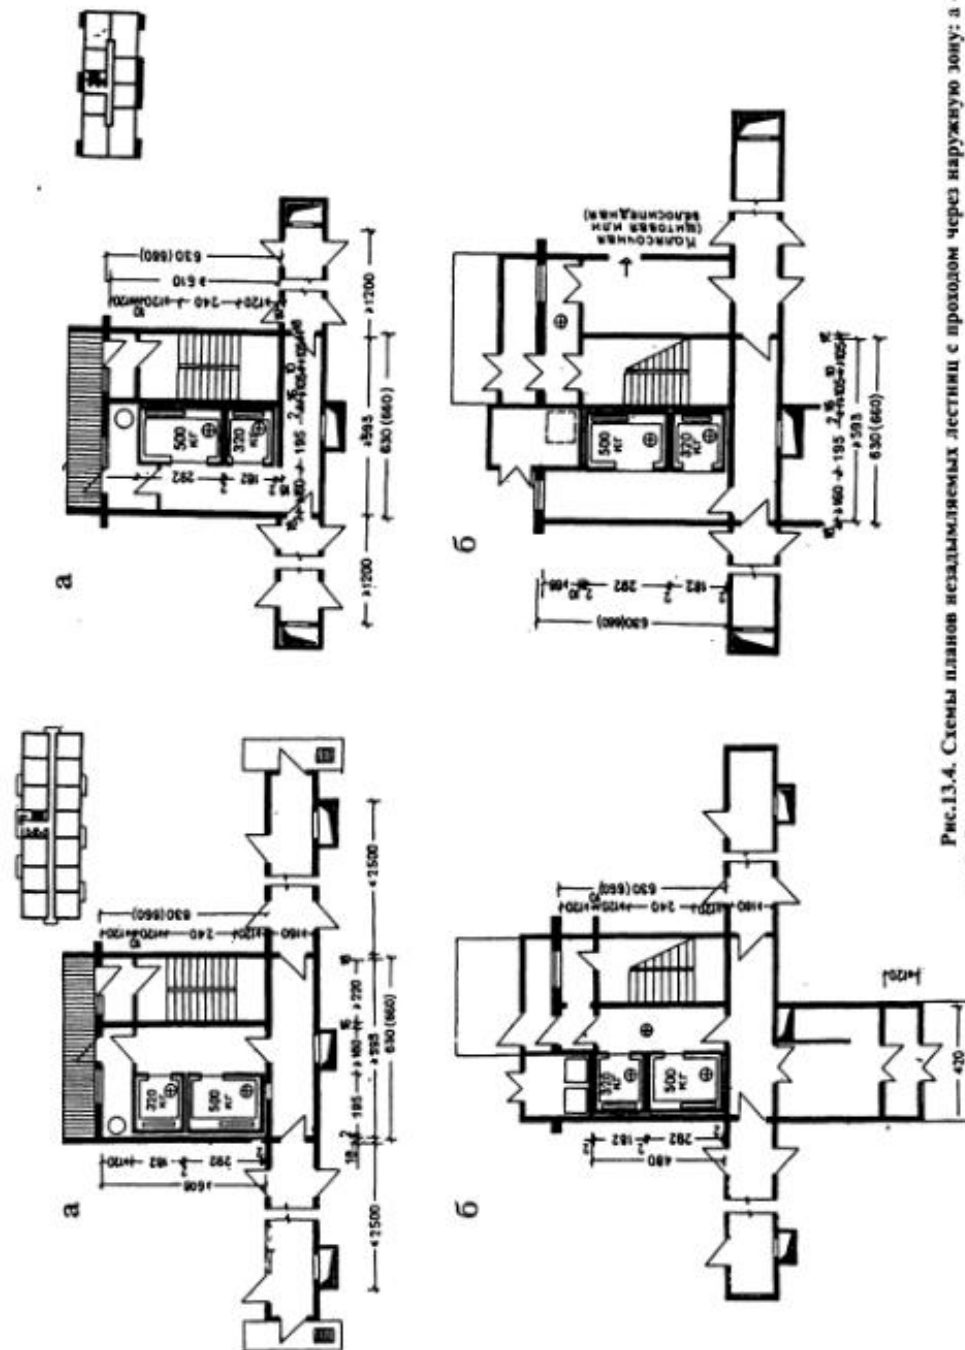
Схемы планов незадымляемых лестниц с проходом через наружную зону: а - типовой; б - первый этаж
